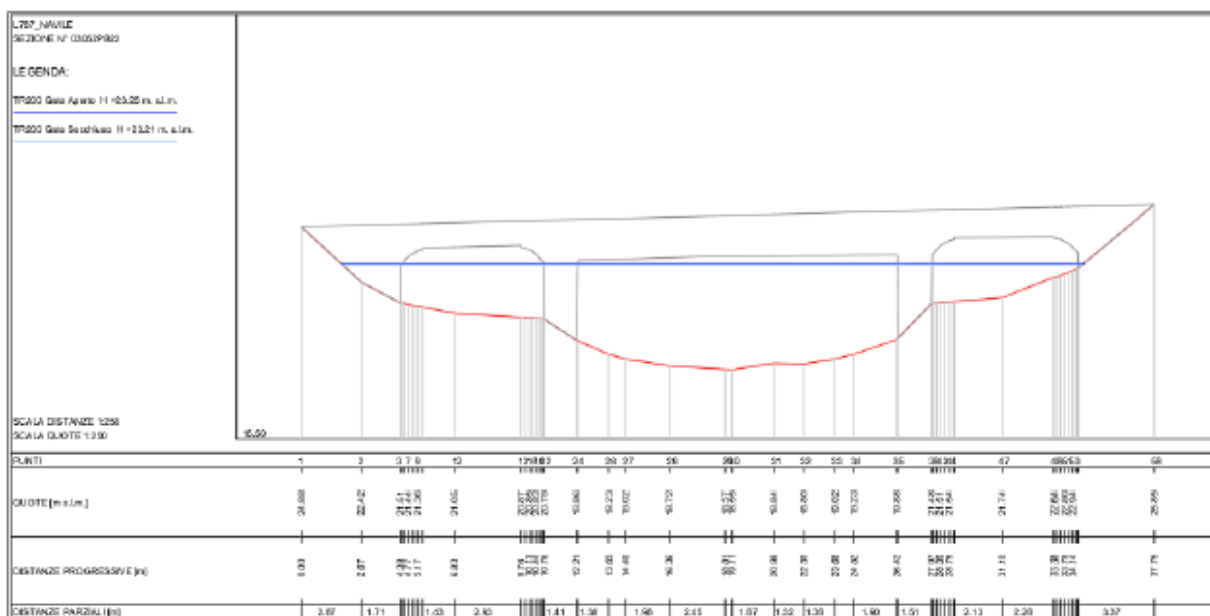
Adeguamento ponte via Bentini – Sezione di verifica idraulica
